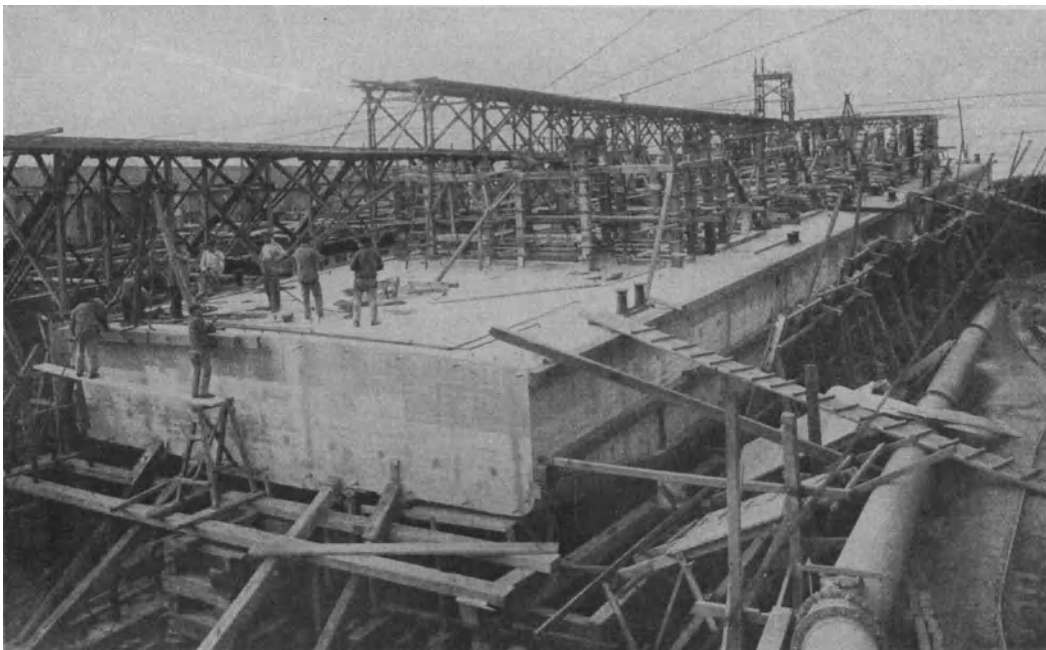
Bau eines Eisenbeton-Anlegeschiefes für den Paraná auf der Staatswerft der Wasserstraßenverwaltung in Buenos Aires.
